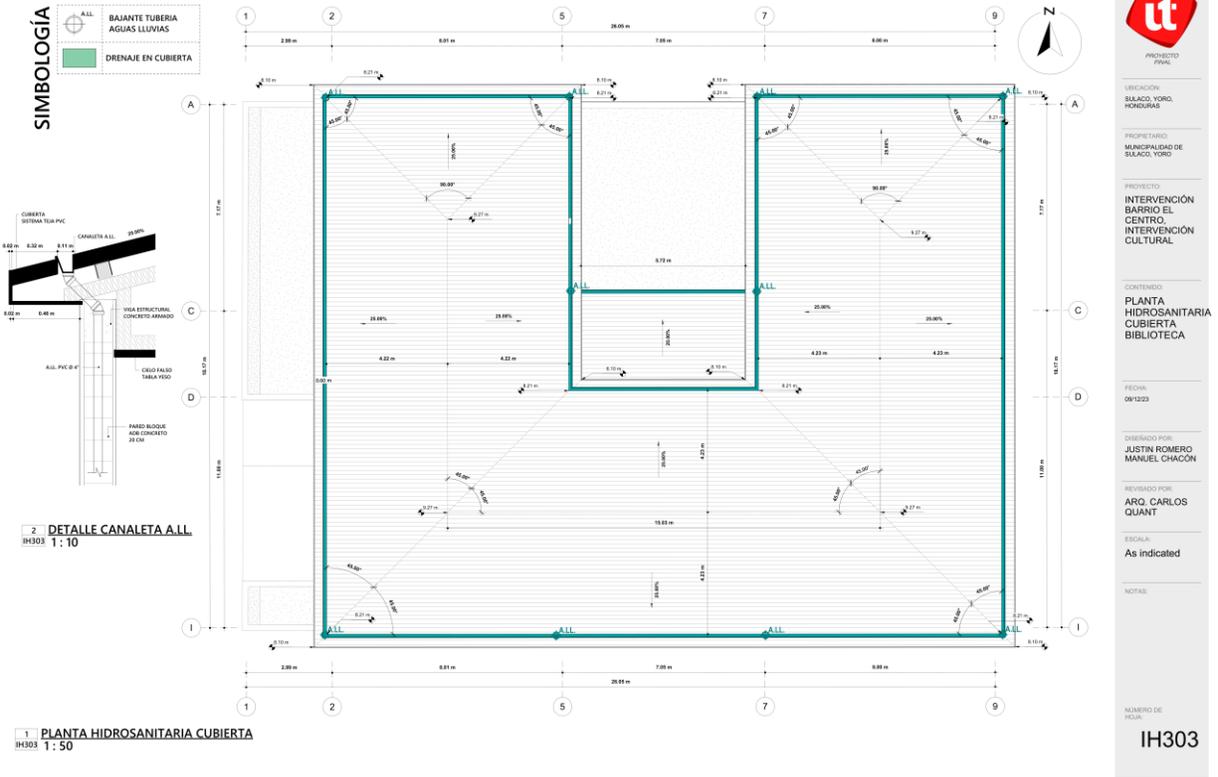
Planta Hidrosanitaria Cubierta | Fuente: elaboración Propia
